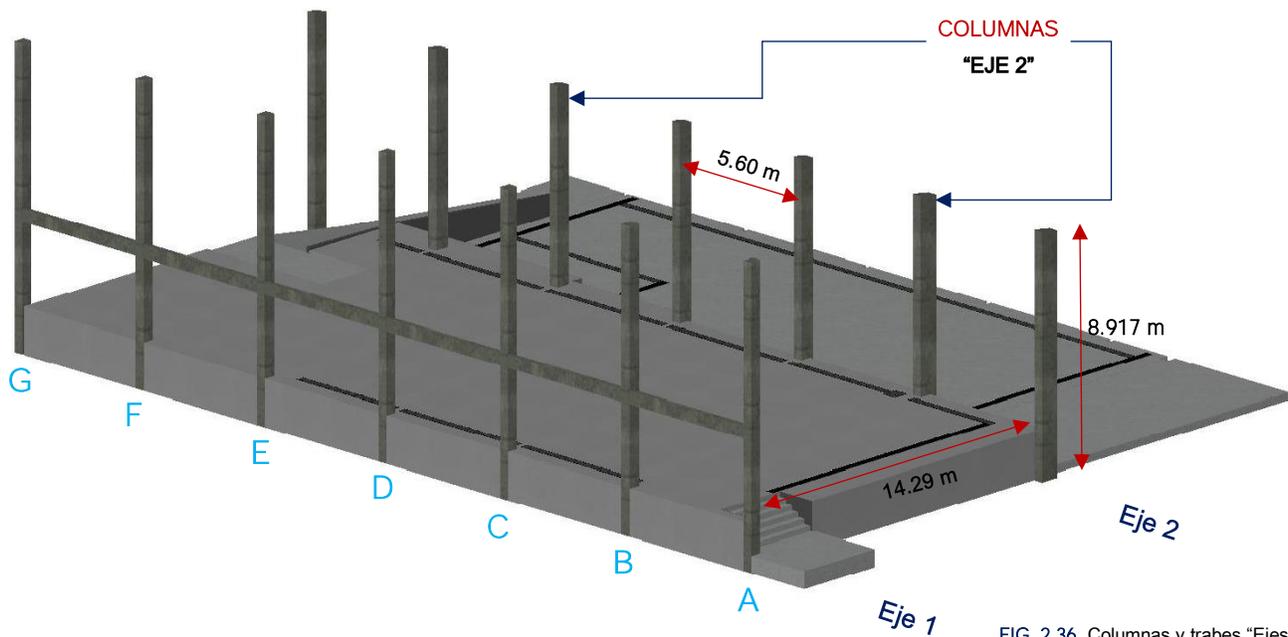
Columnas y travesaños “Ejes 1 - 2”.
